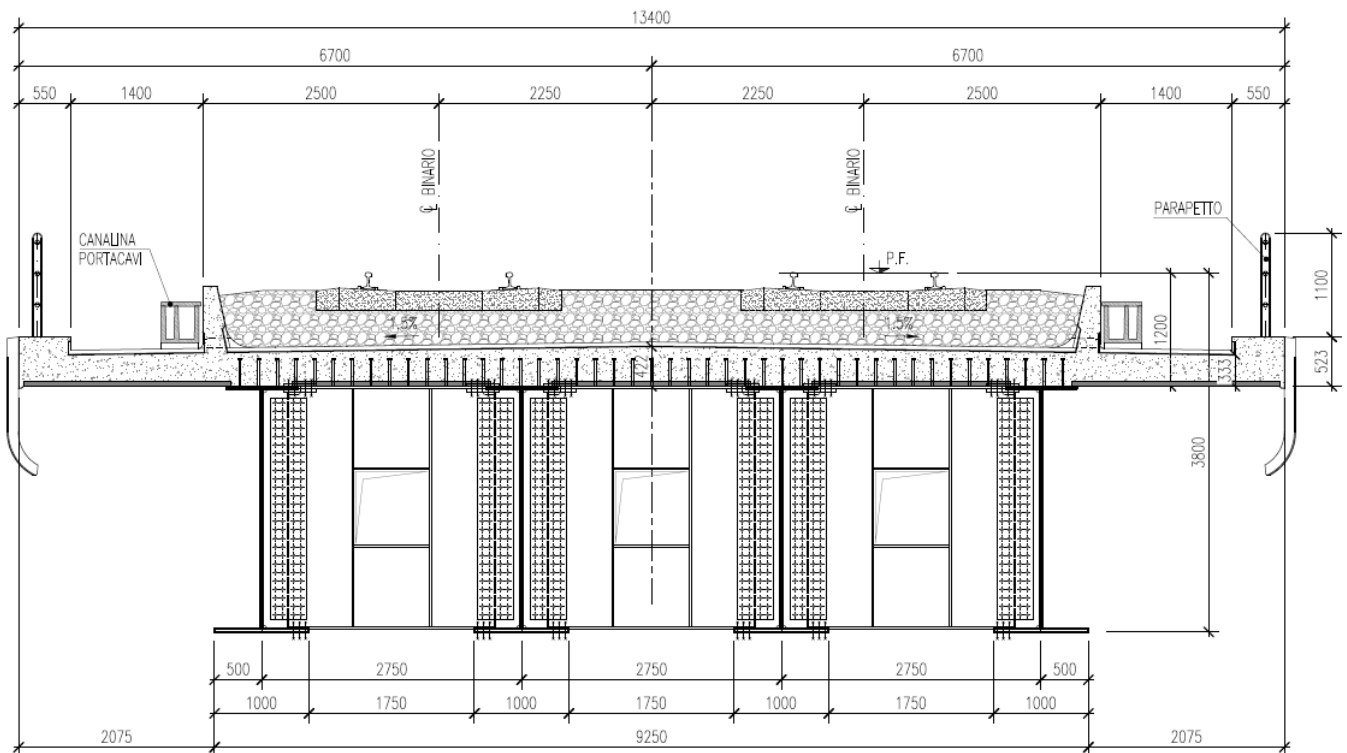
Sezione trasversale tipo dell'impalcato da 40 m (4 travi).
